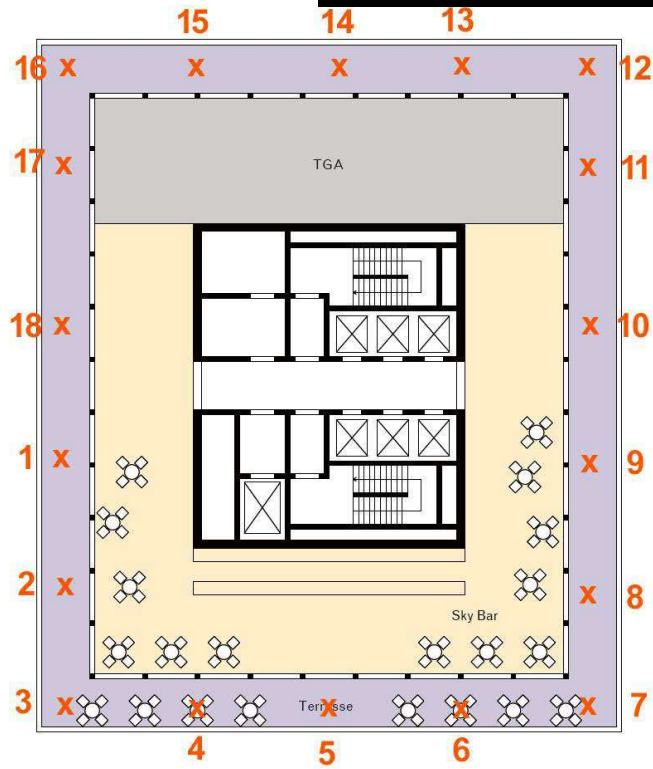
Grundriss 24:OG mit Messpositionen Nr.1 – Nr.18 auf Terrasse der Skybar für Variante 1b
